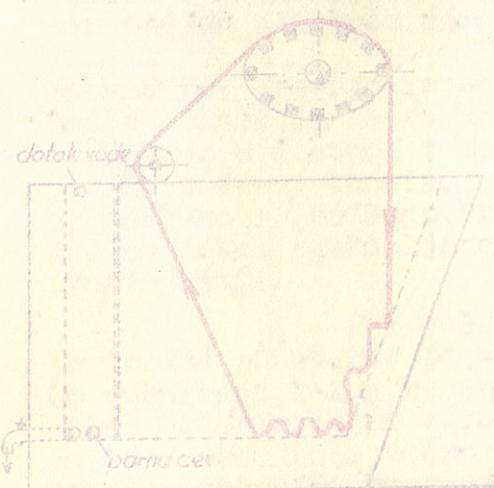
Stroj za izpiranje preden od. tvrdke Zittauer Maschinenfabrik, A.G. Zittau.
